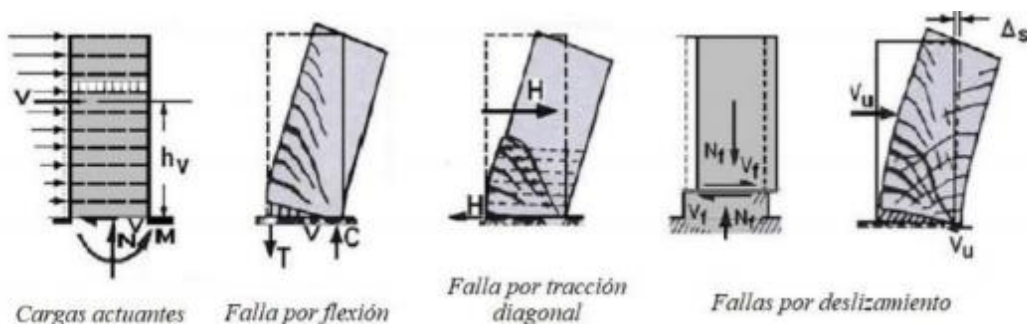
Mecanismos de Rotura en Muros de Concreto Armado
